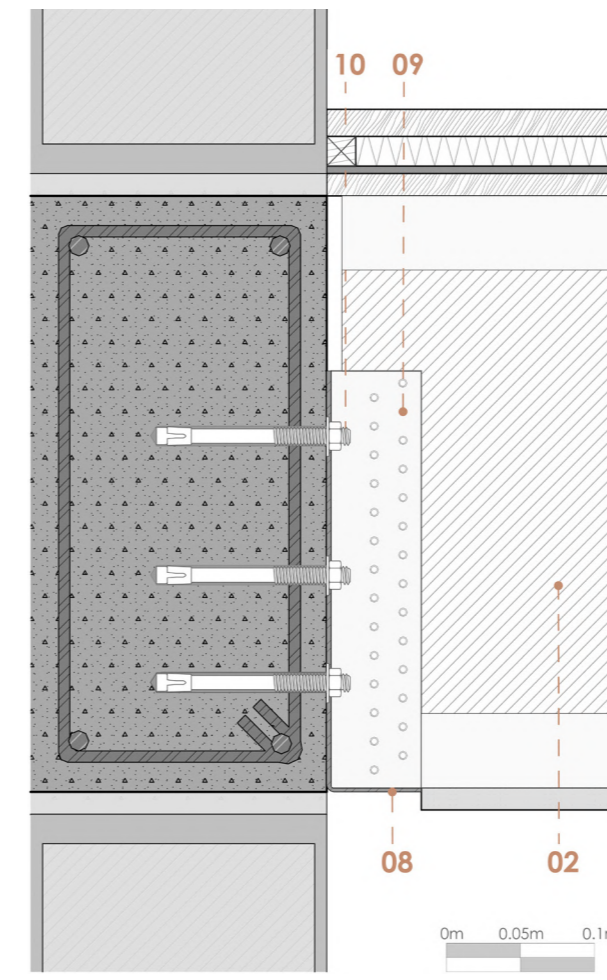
Detalle constructivo del entrepiso empotrado universal
